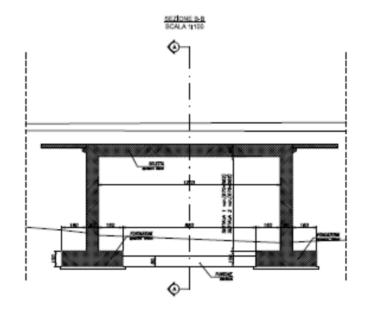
Sezione trasversale sottopasso Svincolo Settala
